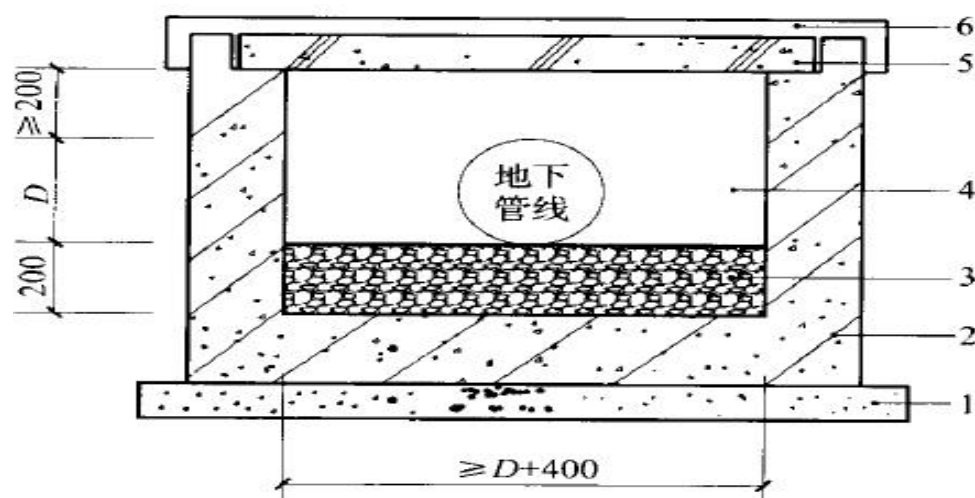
抗渗钢筋混凝土管沟防渗层示意
